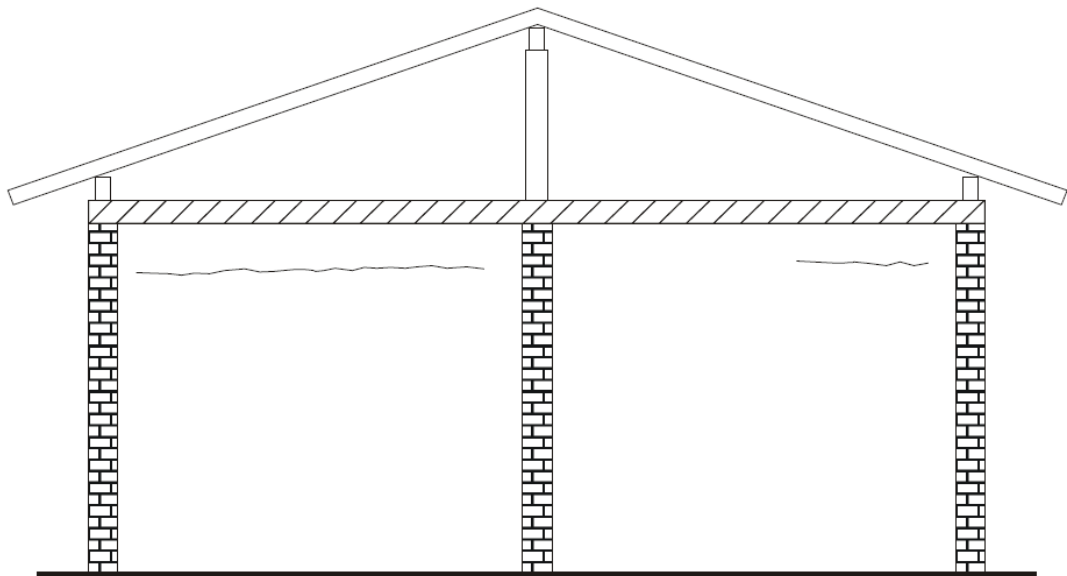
Fissuras horizontais causadas por dilatação térmica da laje de cobertura.
